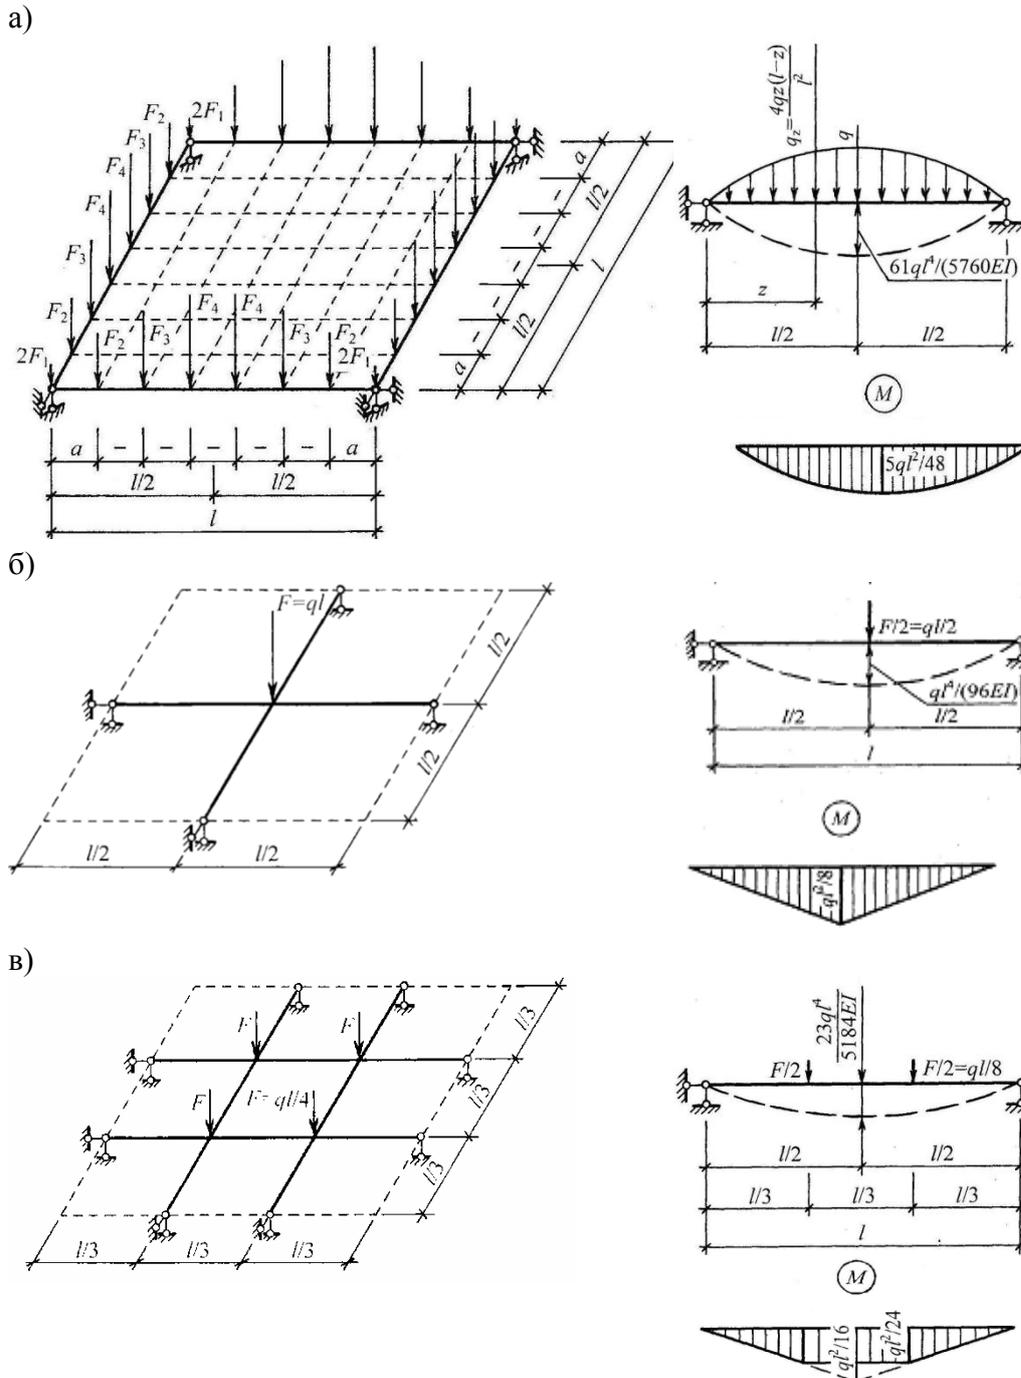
Расчетные схемы балочных аналогов перекрестных ферм:
